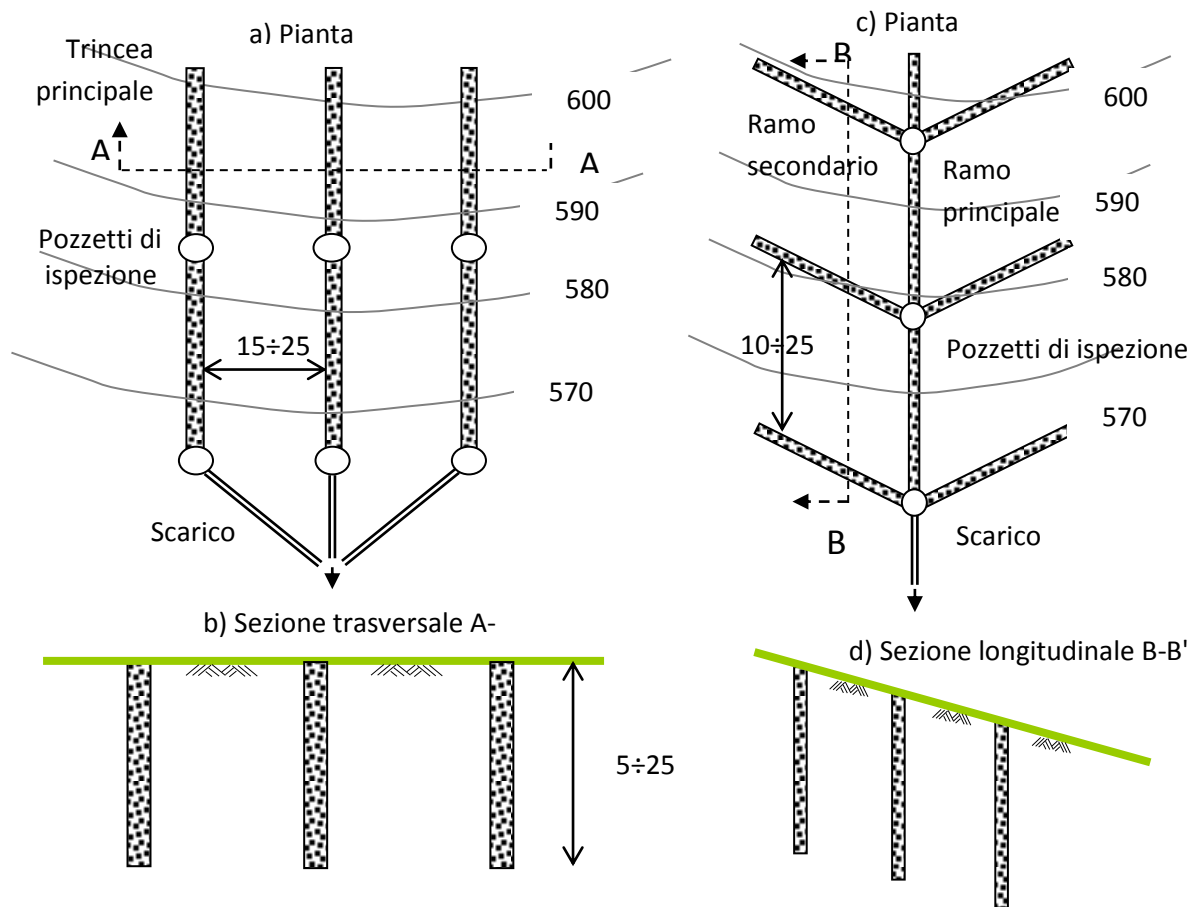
trincee profonde con soli rami principali: a) pianta, b) sezione trasversale. Trincee superficiali, con rami principali e secondari: c) pianta, d) sezione longitudinale.
